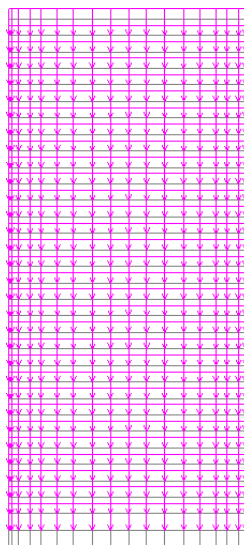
Схема прикладання навантажень на перекриття
